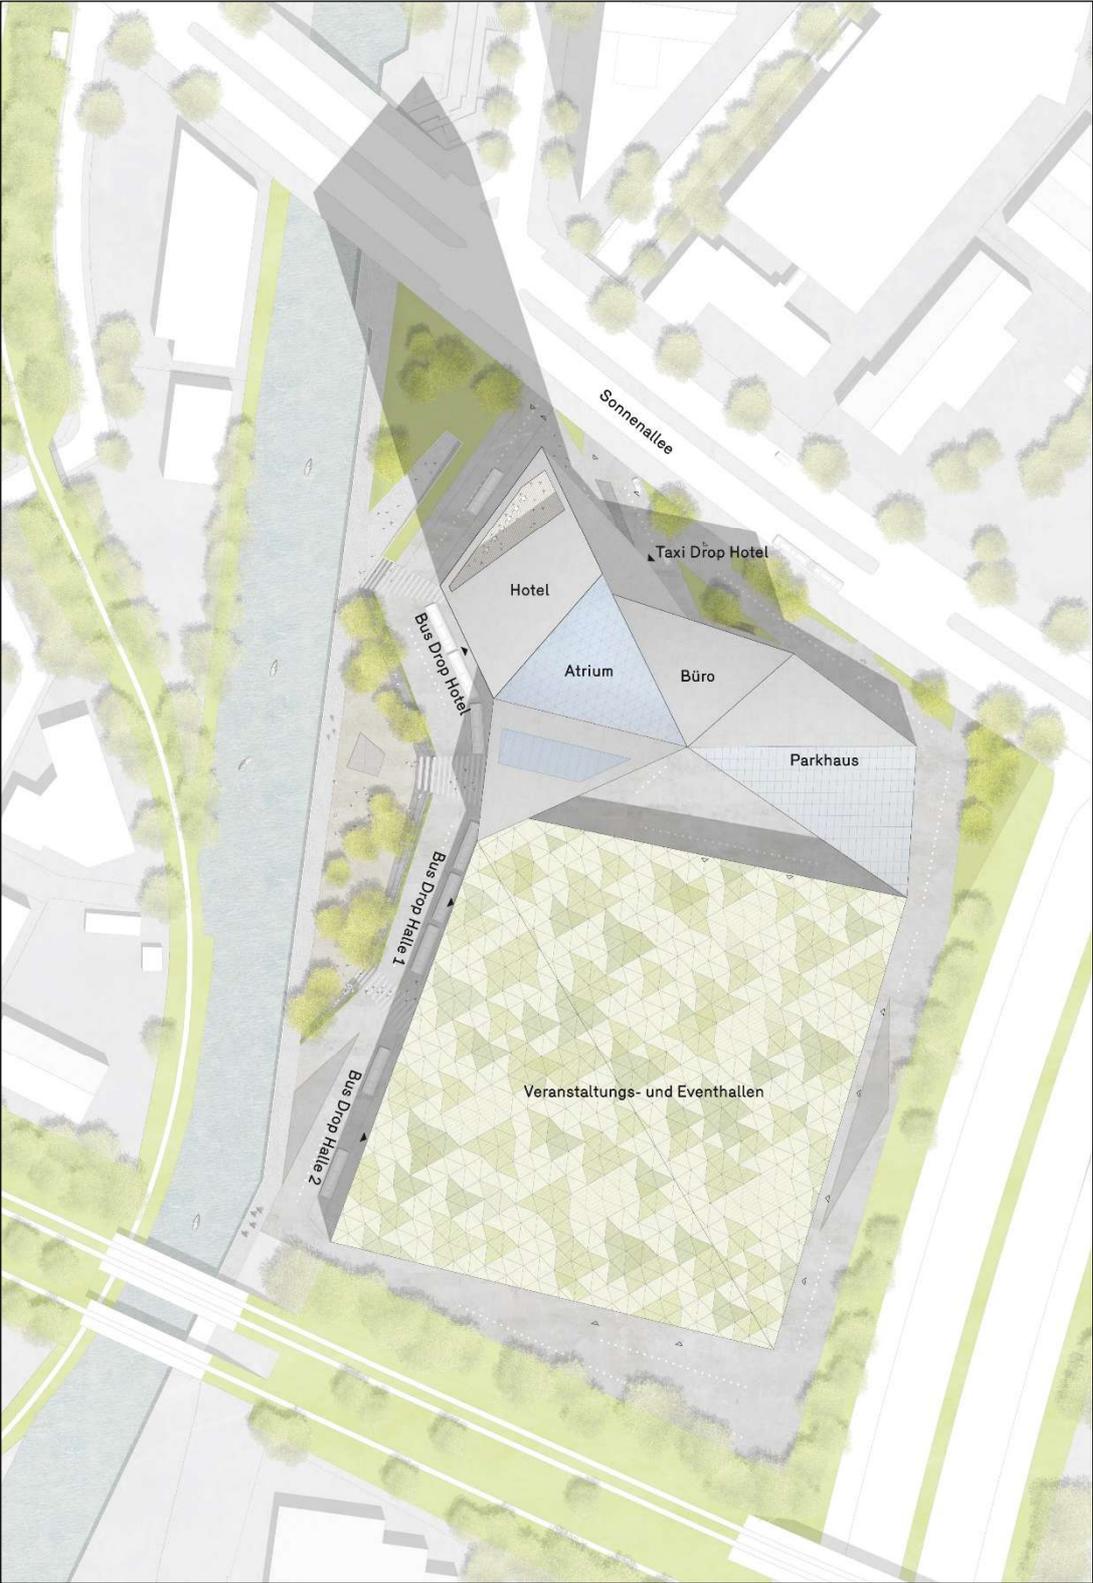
Lageplan Siegerentwurf (Quelle: Barkow Leibinger), ohne Maßstab
